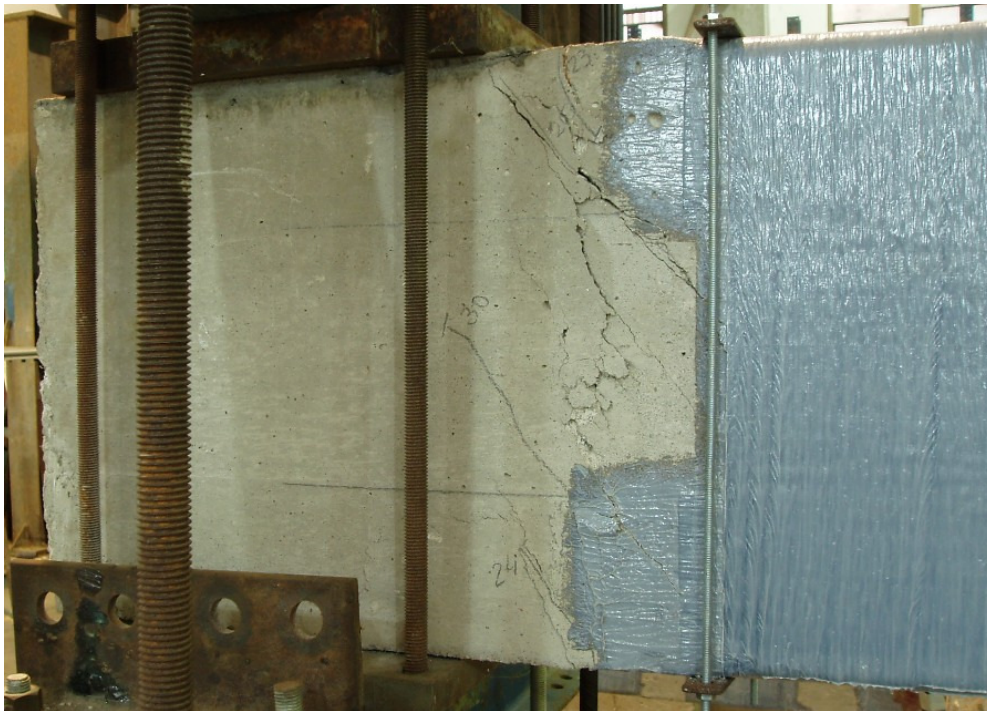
Detalhe da ruptura da viga VTL2 vista da esquerda.
